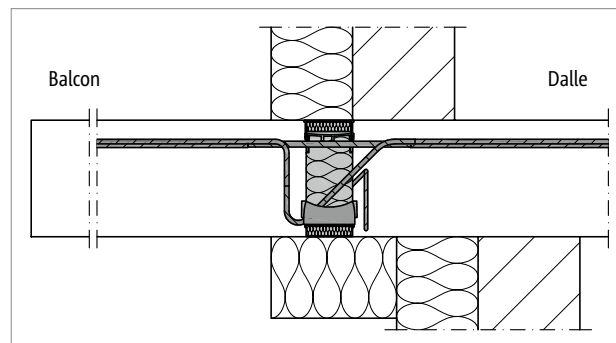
Schöck Isokorb® T Type K-E, K-T : Raccordement pour plancher indirect et ETICS
